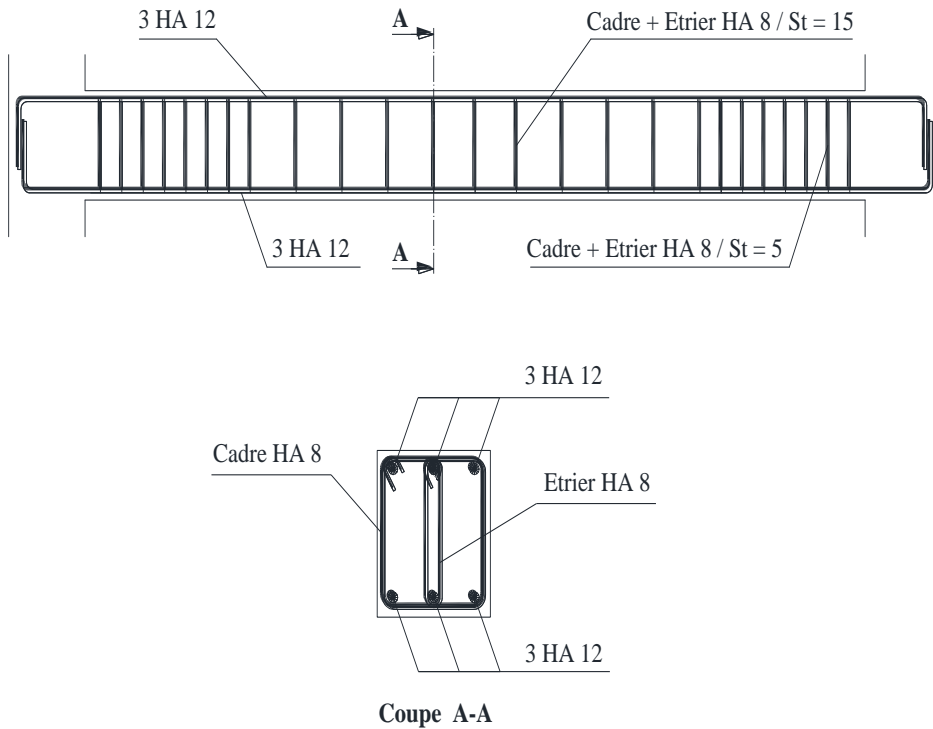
Schéma de ferrailage de la poutre palière.
